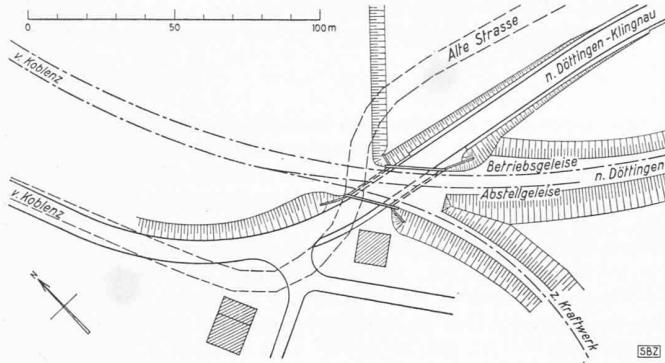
Strassenunterführung bei Koblenz. Lageplan 1 : 2500
